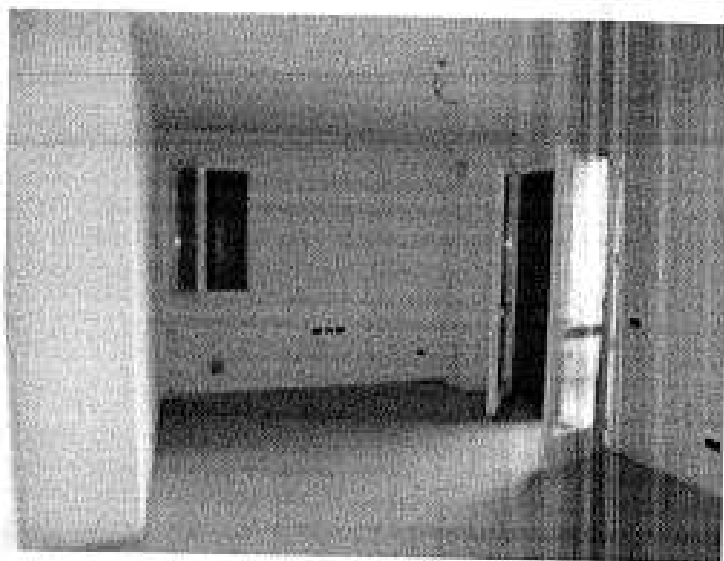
Blocco -b-: Bagno Abitazione Tipo P.1:
